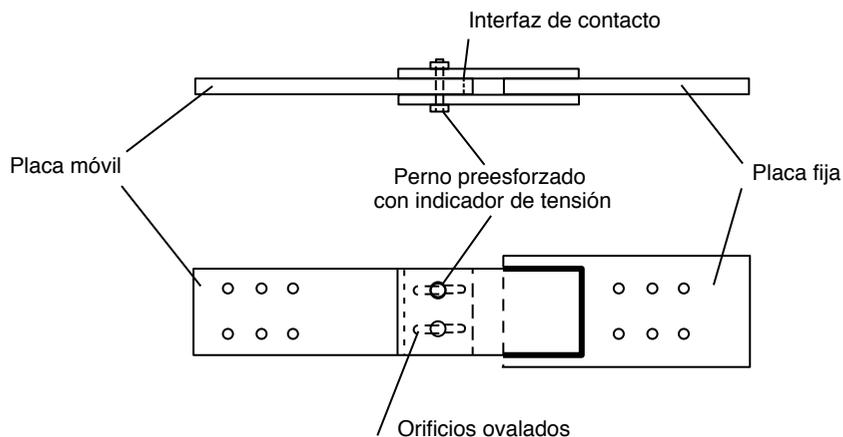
Conexión tipo SBC (Slotted Bolted Connection).
